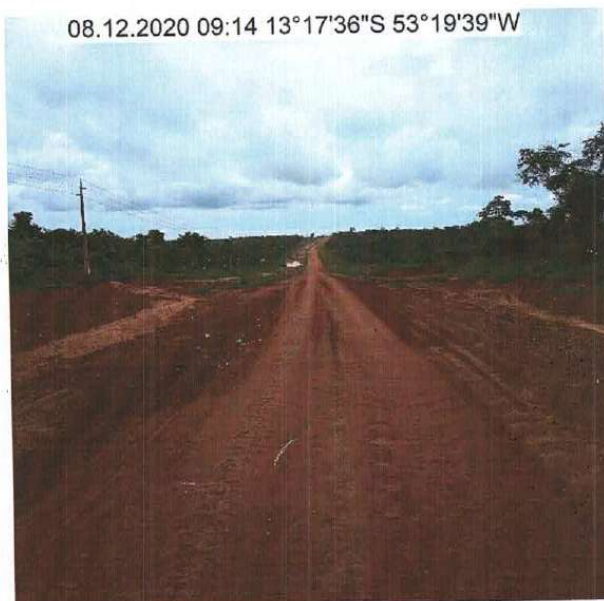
FINAL DO TRECHO EM TERRAPLENAGEM
